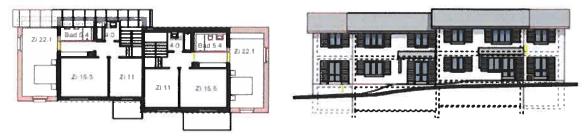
giebelseitiger, zweigeschossiger Anbau bei einem Doppeleinfamilienhaus mit je rund 56 m² Erweiterungsfläche
